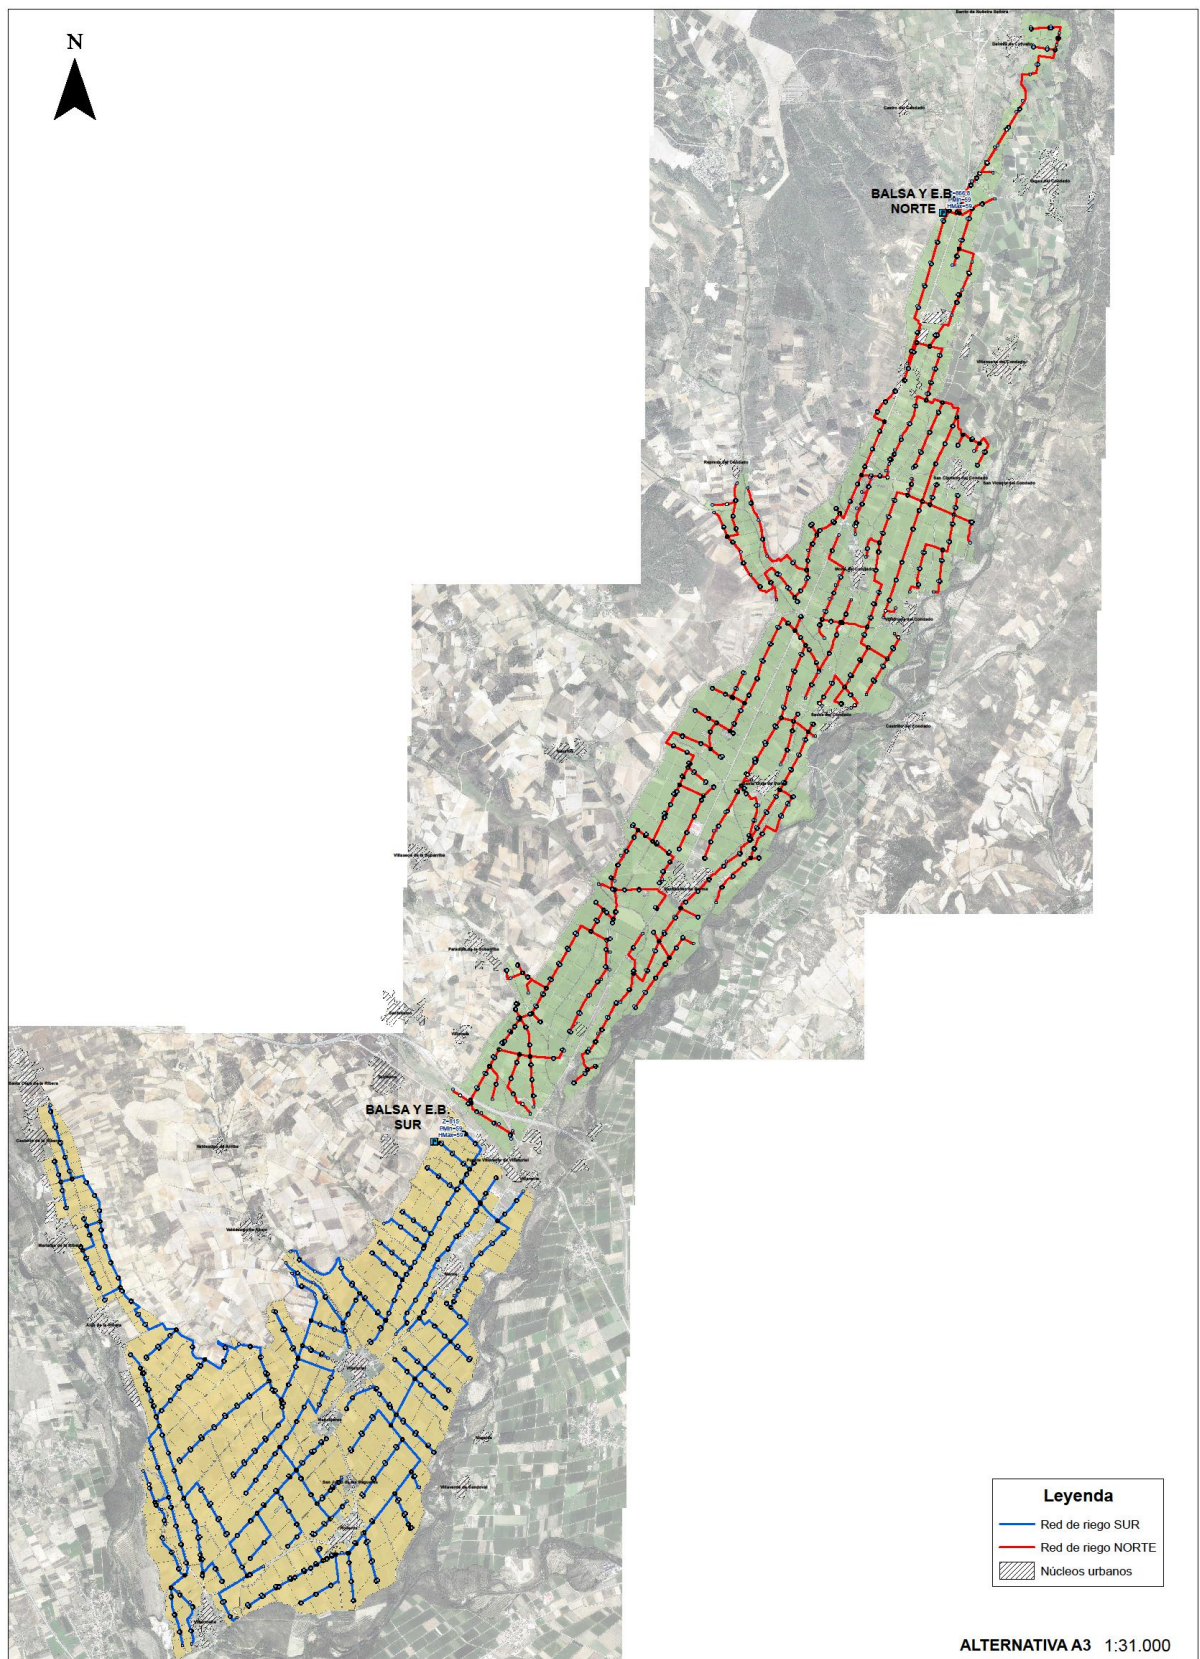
Ubicación de las infraestructuras en la Alternativa 3
